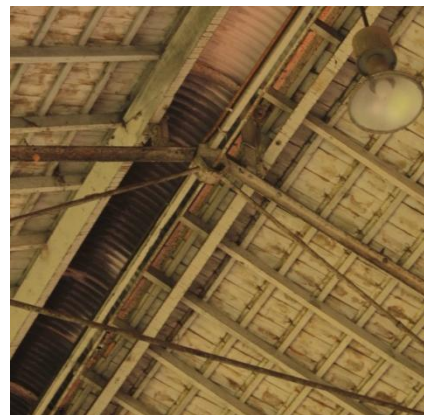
177: Ligação tesoura e pilar - Elétrica
